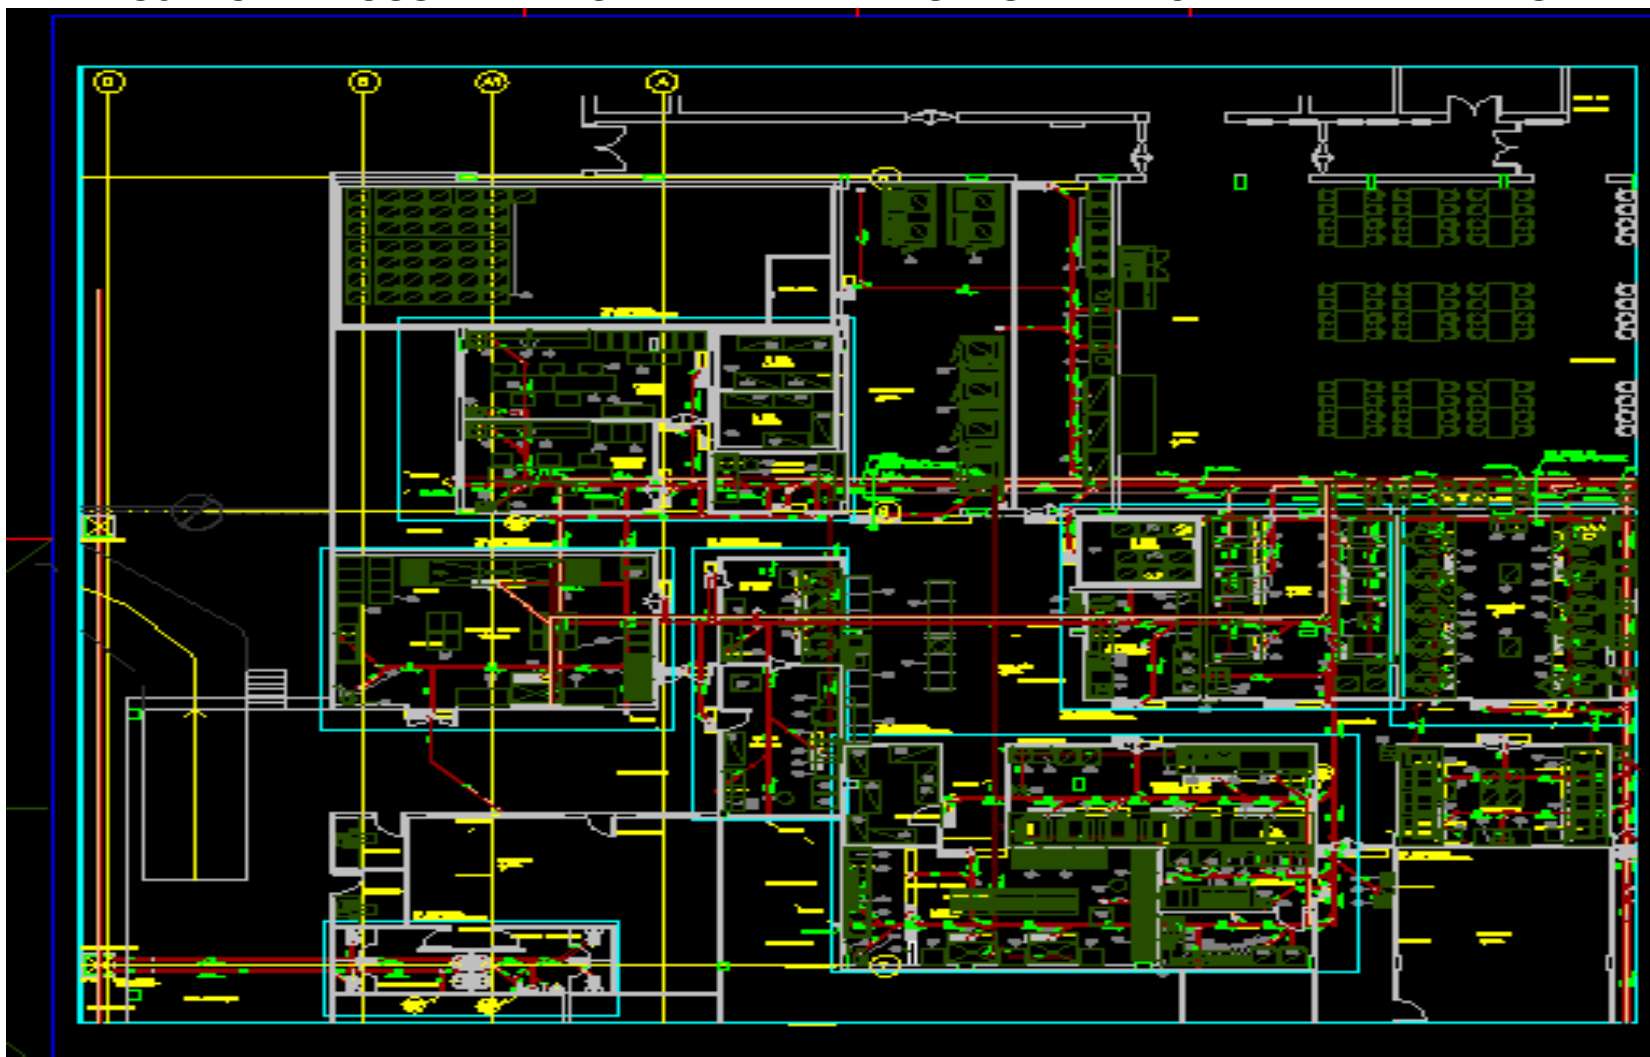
Projeto hidrossanitário – Planta 1 - Restaurante Central da VALE S.A
